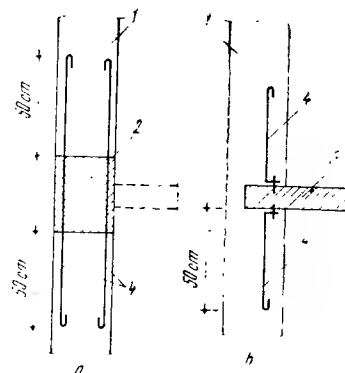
Legarea pereților de umplutură de elementele de rezistență: a - cu mustăți lăsate la turnare; b - cu mustăți sau platbande prinse cu bolturi împuscate; 1 - perete autoportant; 2 - stîlp de beton armat; 3 - diafragmă din beton armat; 4 - mustăți de legătură.
